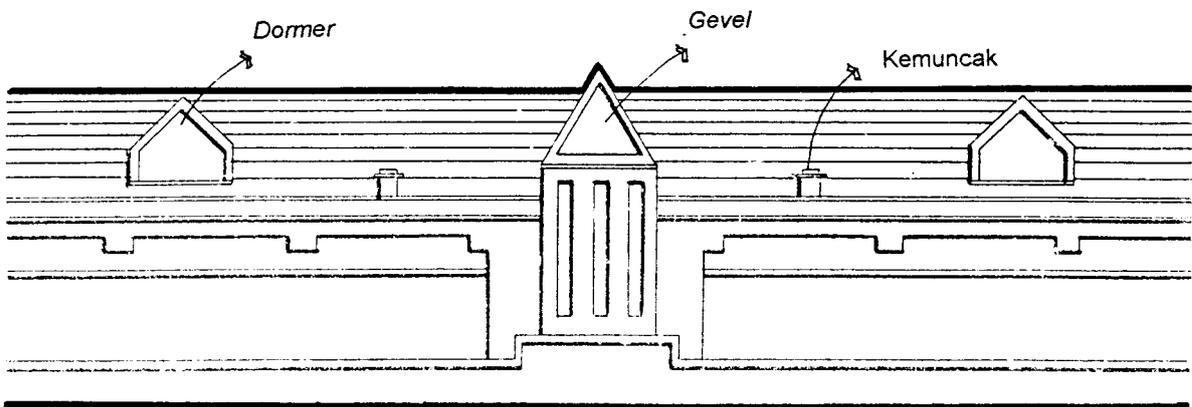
Konsep Penampilan Bangunan dengan Tower
